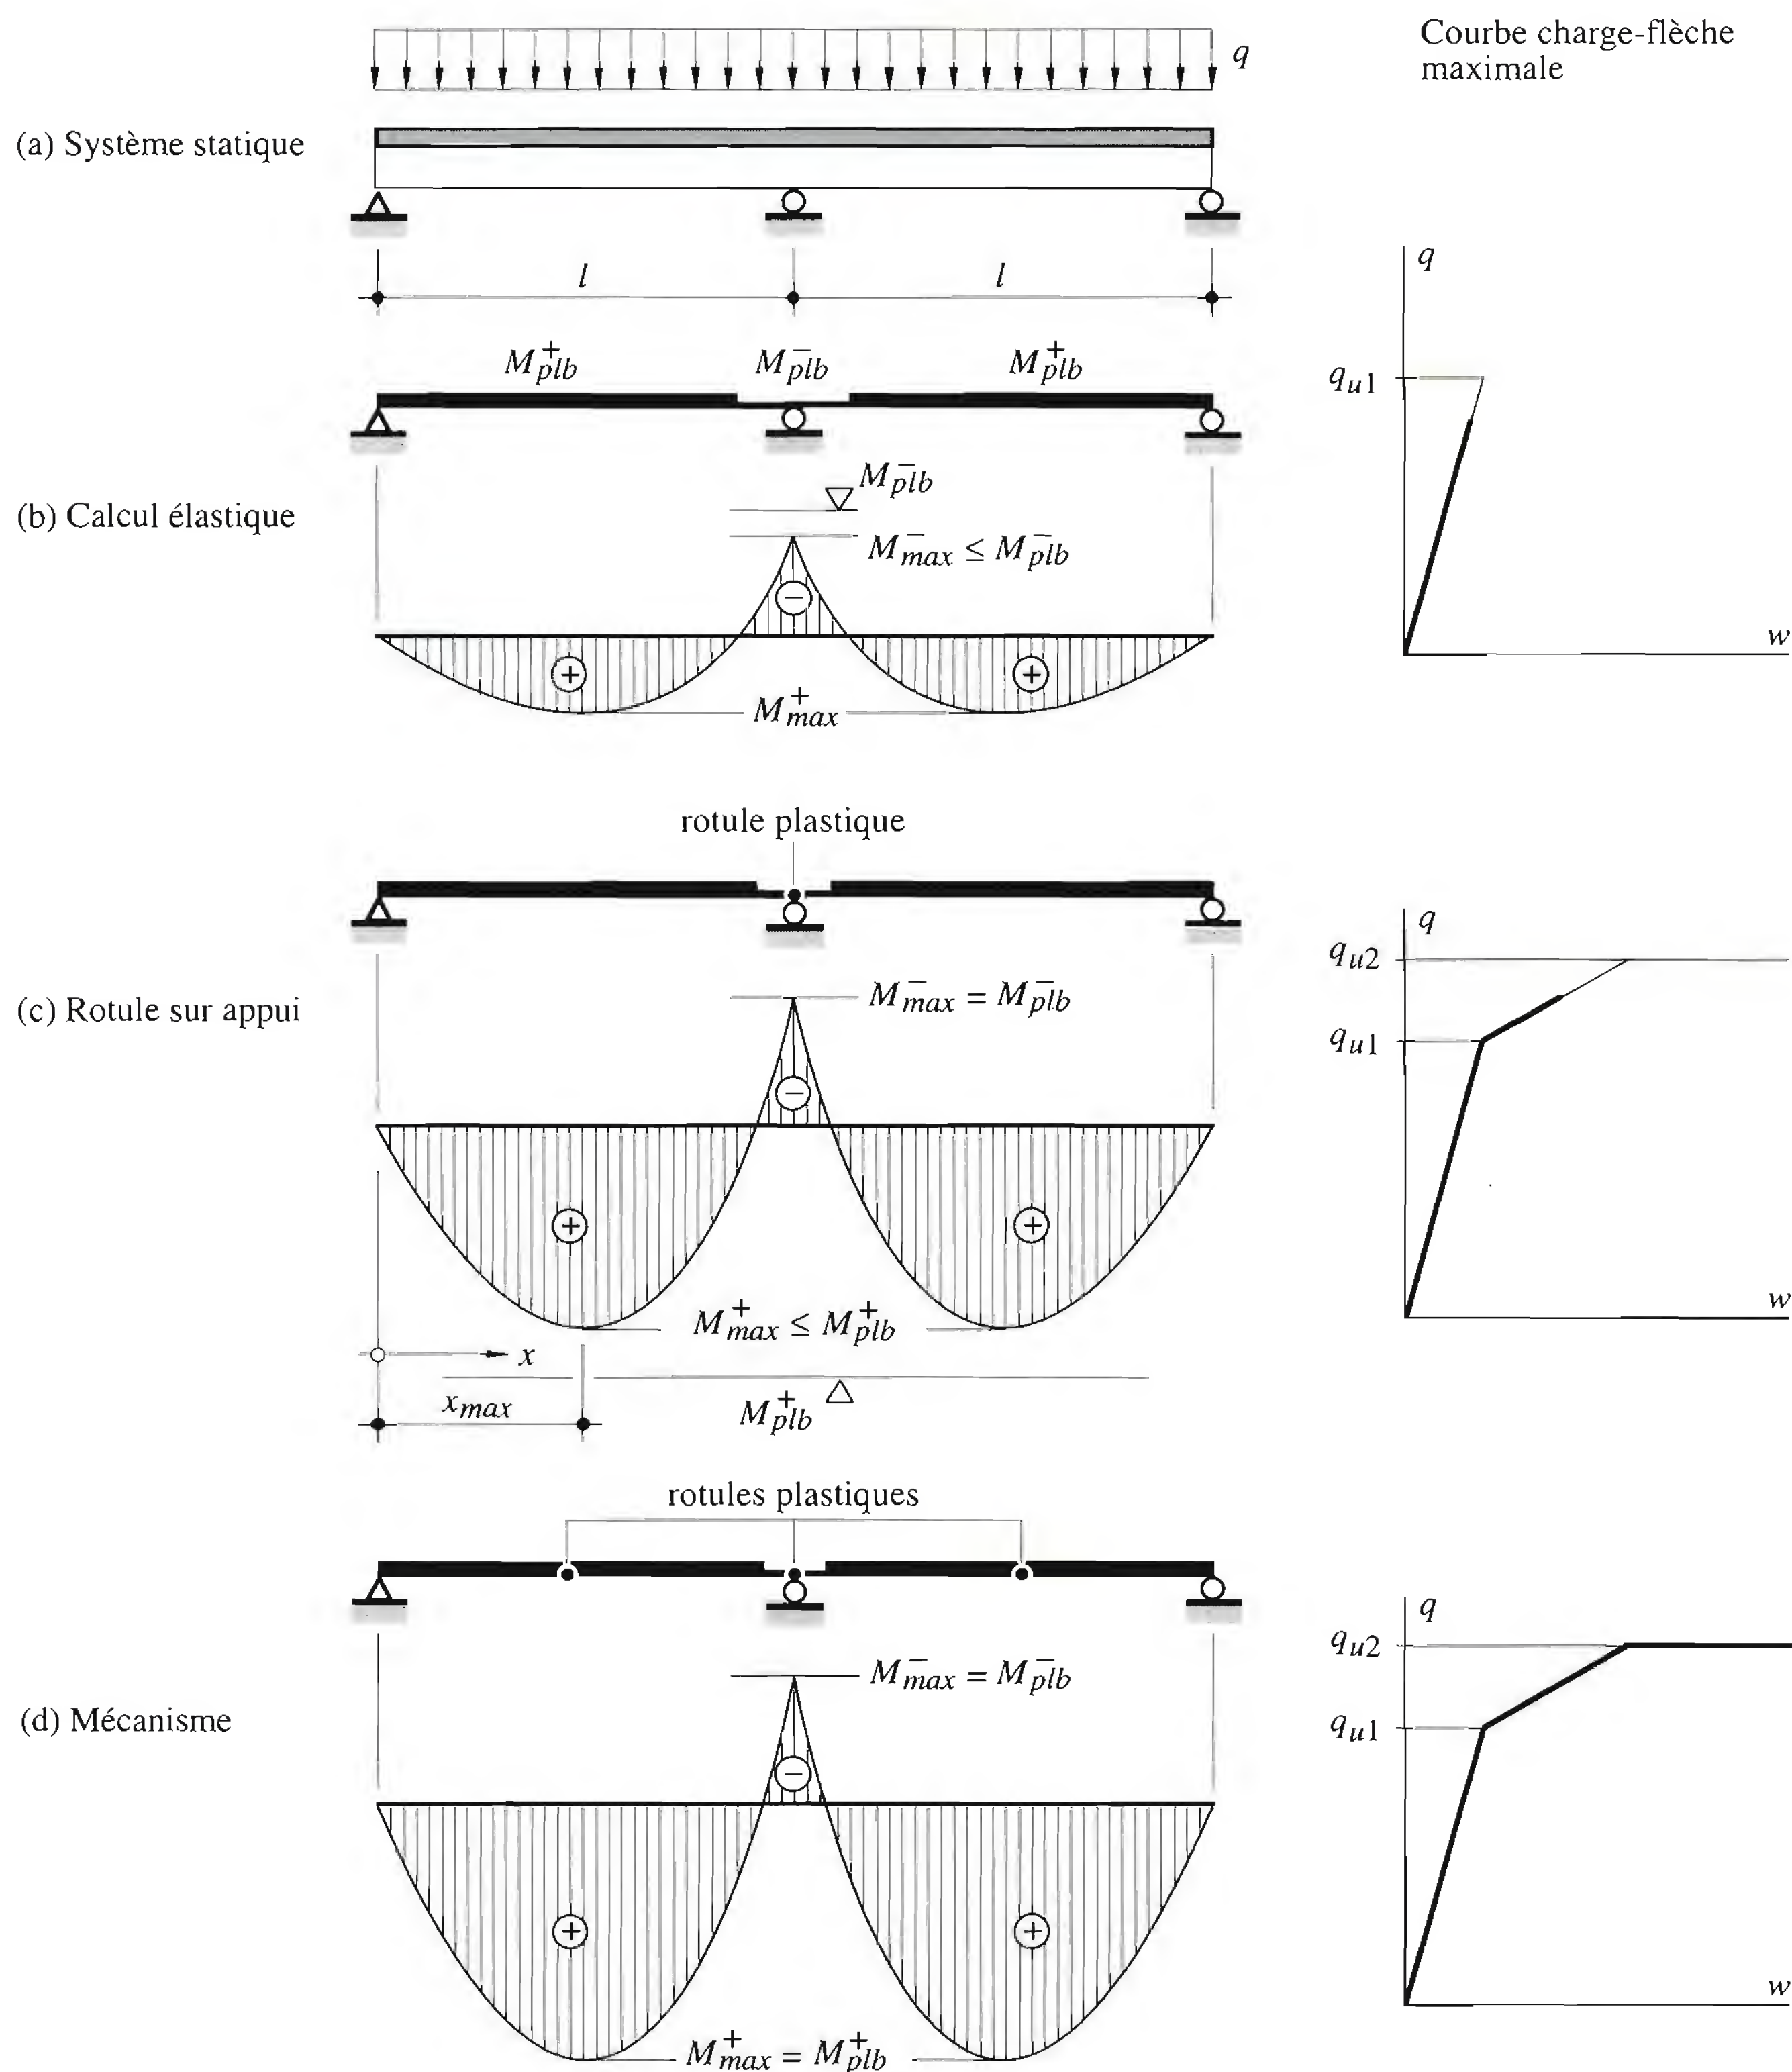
Calcul plastique d'une poutre mixte continue sur trois appuis.
